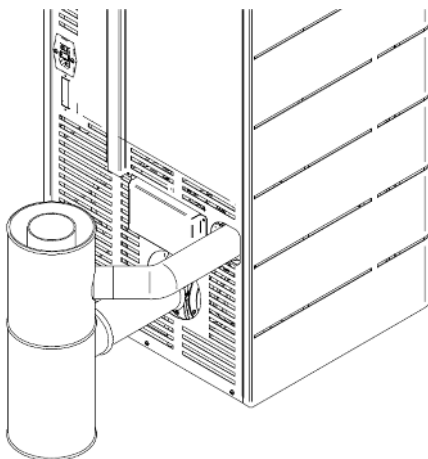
Ajuste coaxial inspección de T y con una pierna horizontal levante
